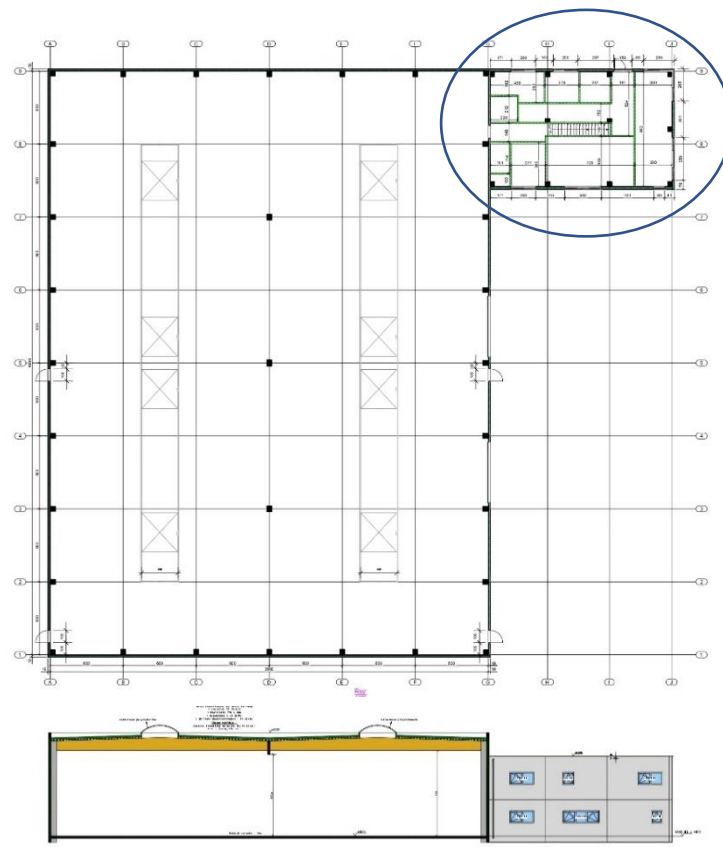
PLAN ET COUPE DES BATIMENTS DE BUREAUX ET DU HALL INDUSTRIEL
